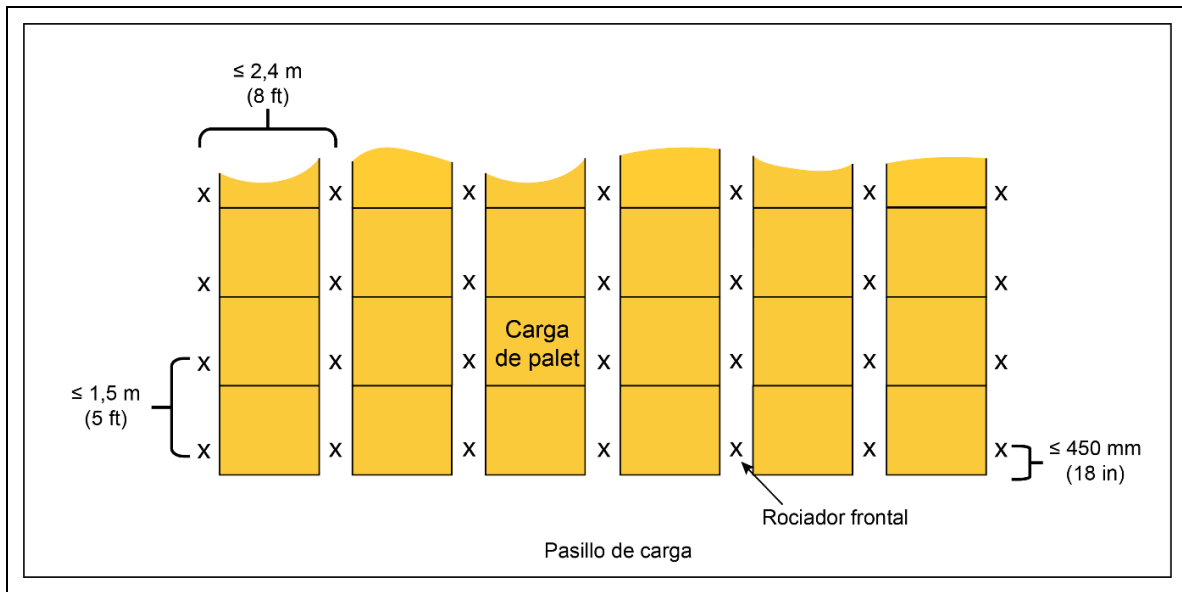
Vista en planta de una configuración horizontal de rociadores intermedios en cada chimenea transversal para estanterías múltiples
